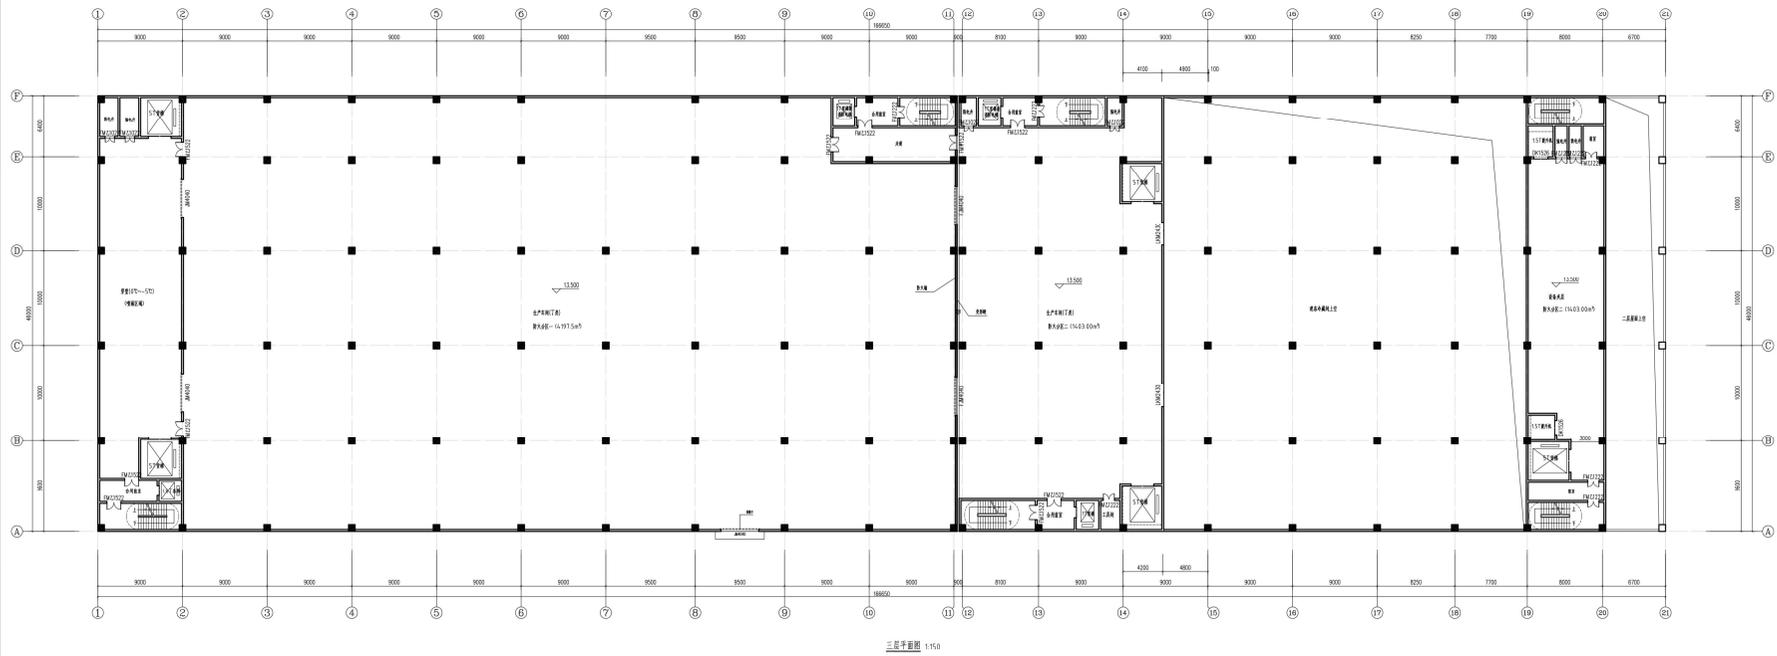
1#厂房二层上空及 2#厂房三层平面布置图
